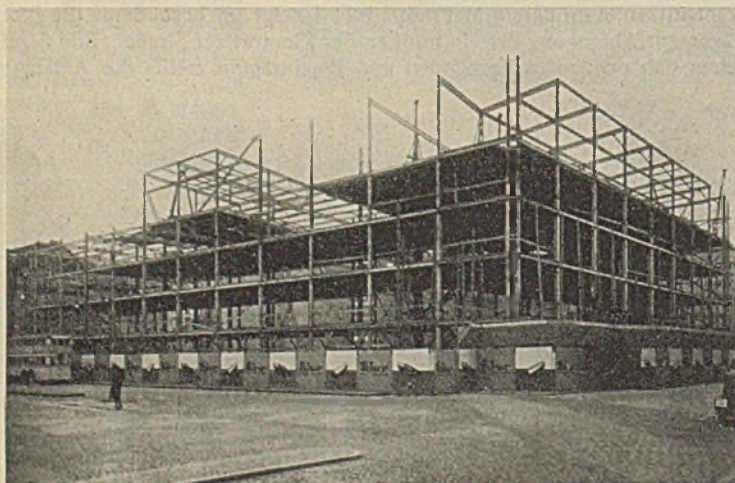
Straßenfront Stettiner Bahnhof und Zinnowitzer Straße.
